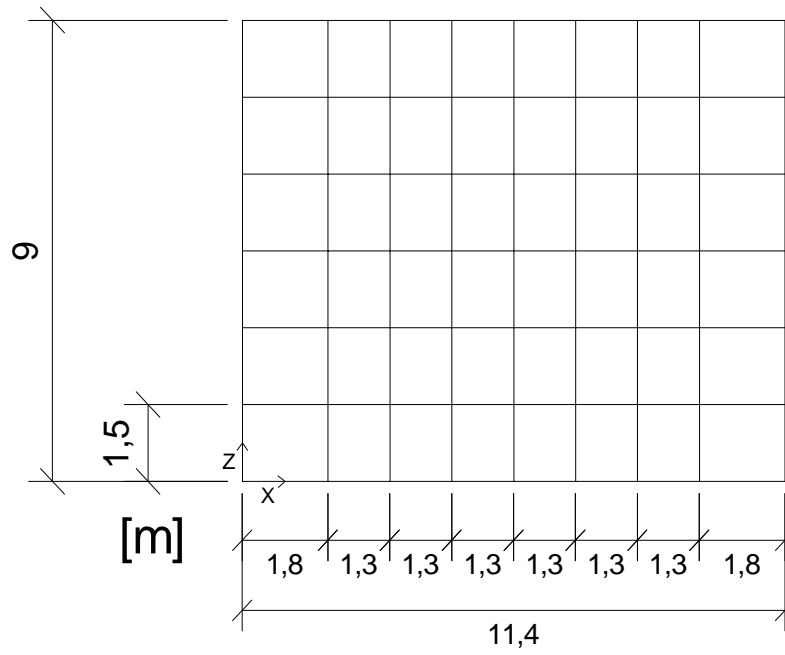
Plano Vertical do Cembre ao Solo Para Uma Secção Tipo de Um Viaduto Com 20 m de Vão
